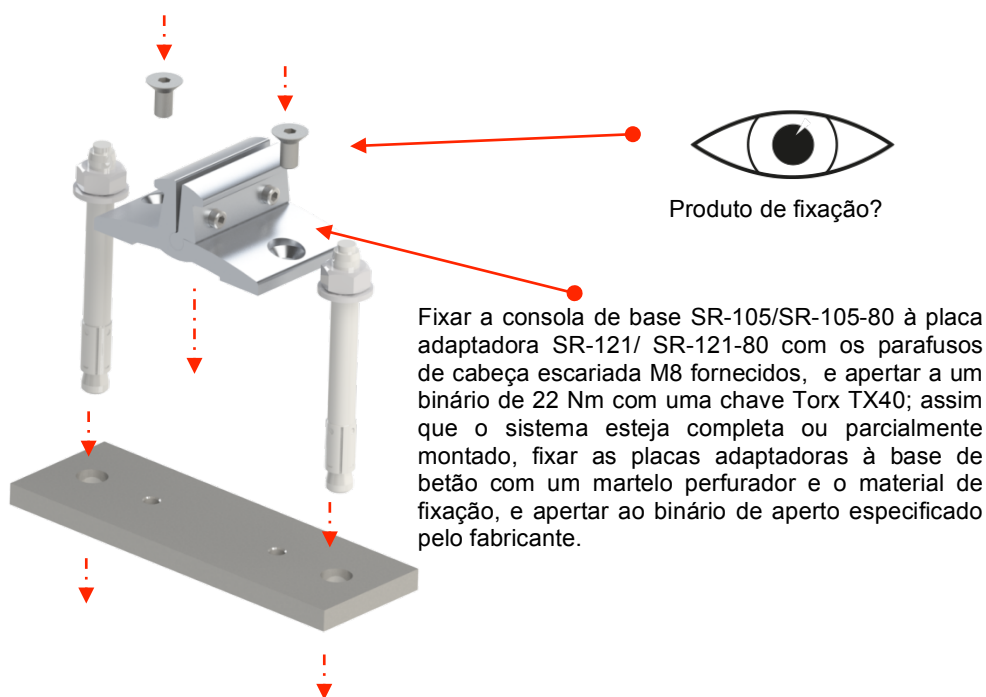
Montagem da consola de base SR-105 na placa adaptadora SR-121/SR-121-80
